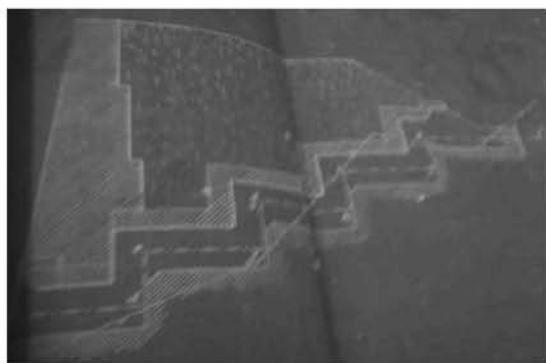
Detall de la secció elaborada d'un drenatge transversal[1].
